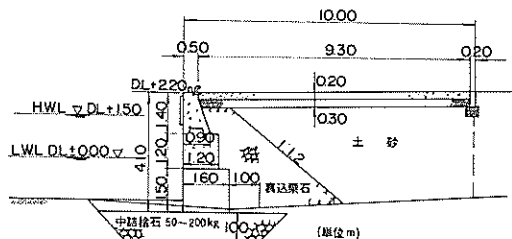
雄勝港立浜物揚場 (-1.5 m) 標準断面図
